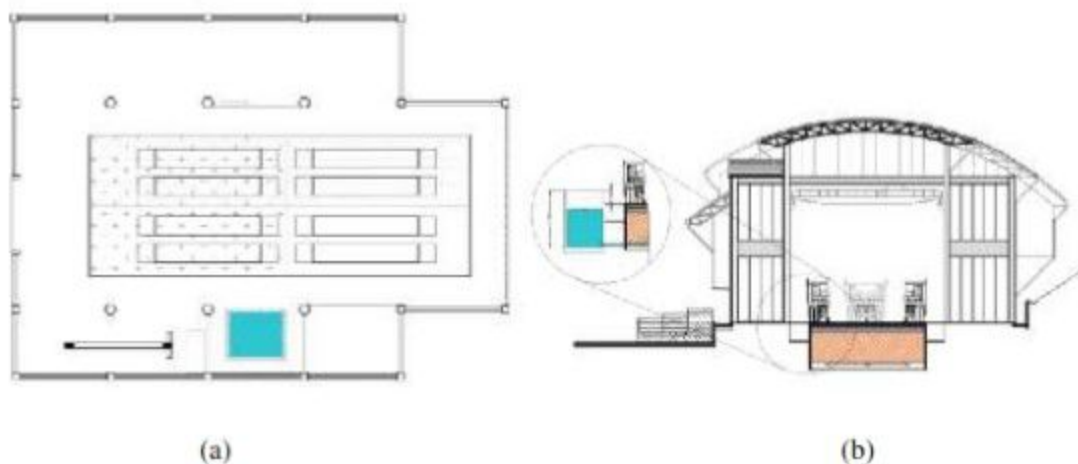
(a) Vista en planta y (b) Vista lateral de las instalaciones del PaveLab, mostrando la conexión del tanque de agua.
